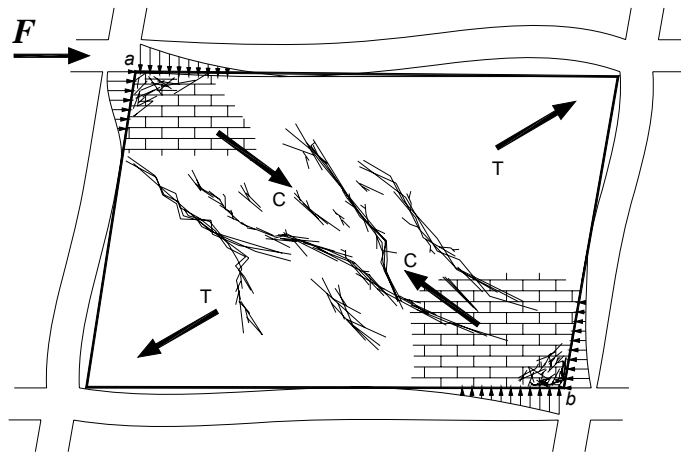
Estado de esfuerzos en un muro de mampostería confinada
